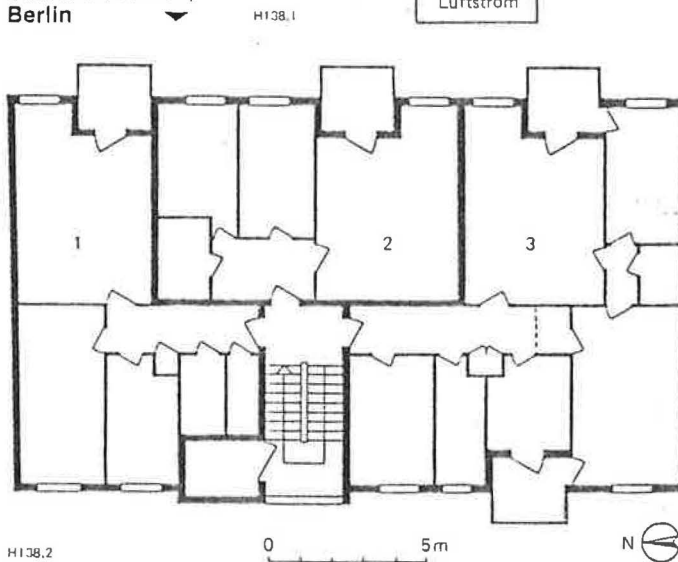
Grundriß Gebäude Brunsbüttler Damm 37, Berlin
